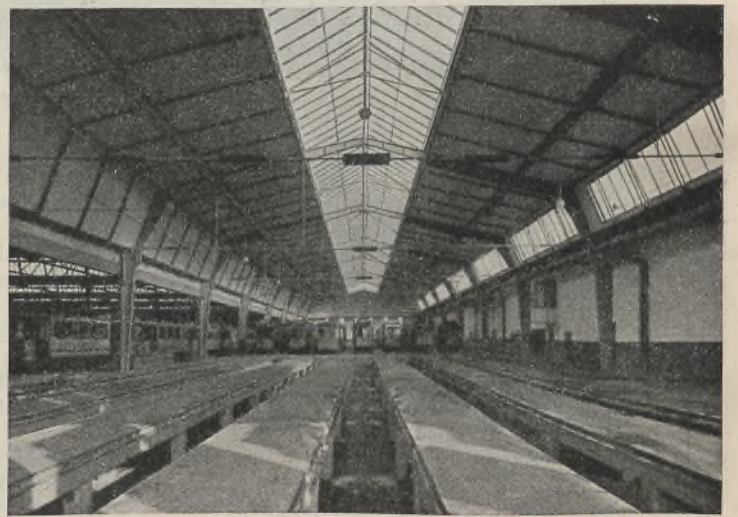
Straßenbahnhof Berlin-Niederschönhausen.
